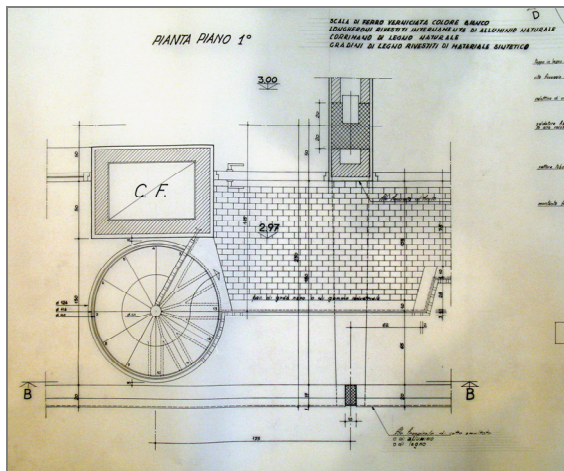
scala di servizio: pianta piano primo (fonte CSAC – stralcio tav. 29, archivio n. 276-1)
